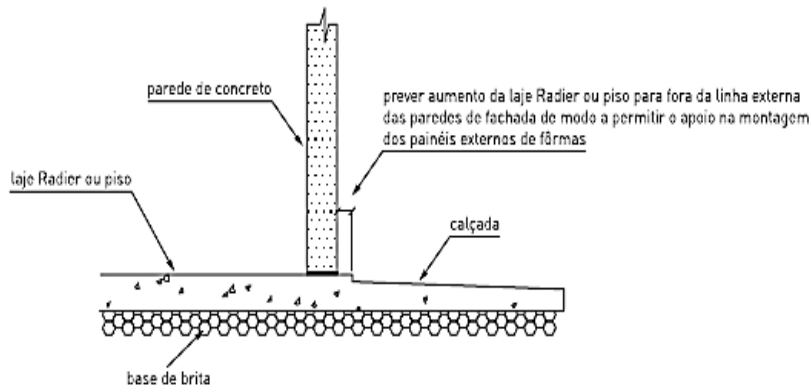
Recomendação de execução de laje/piso nivelador para apoio das fôrmas.
